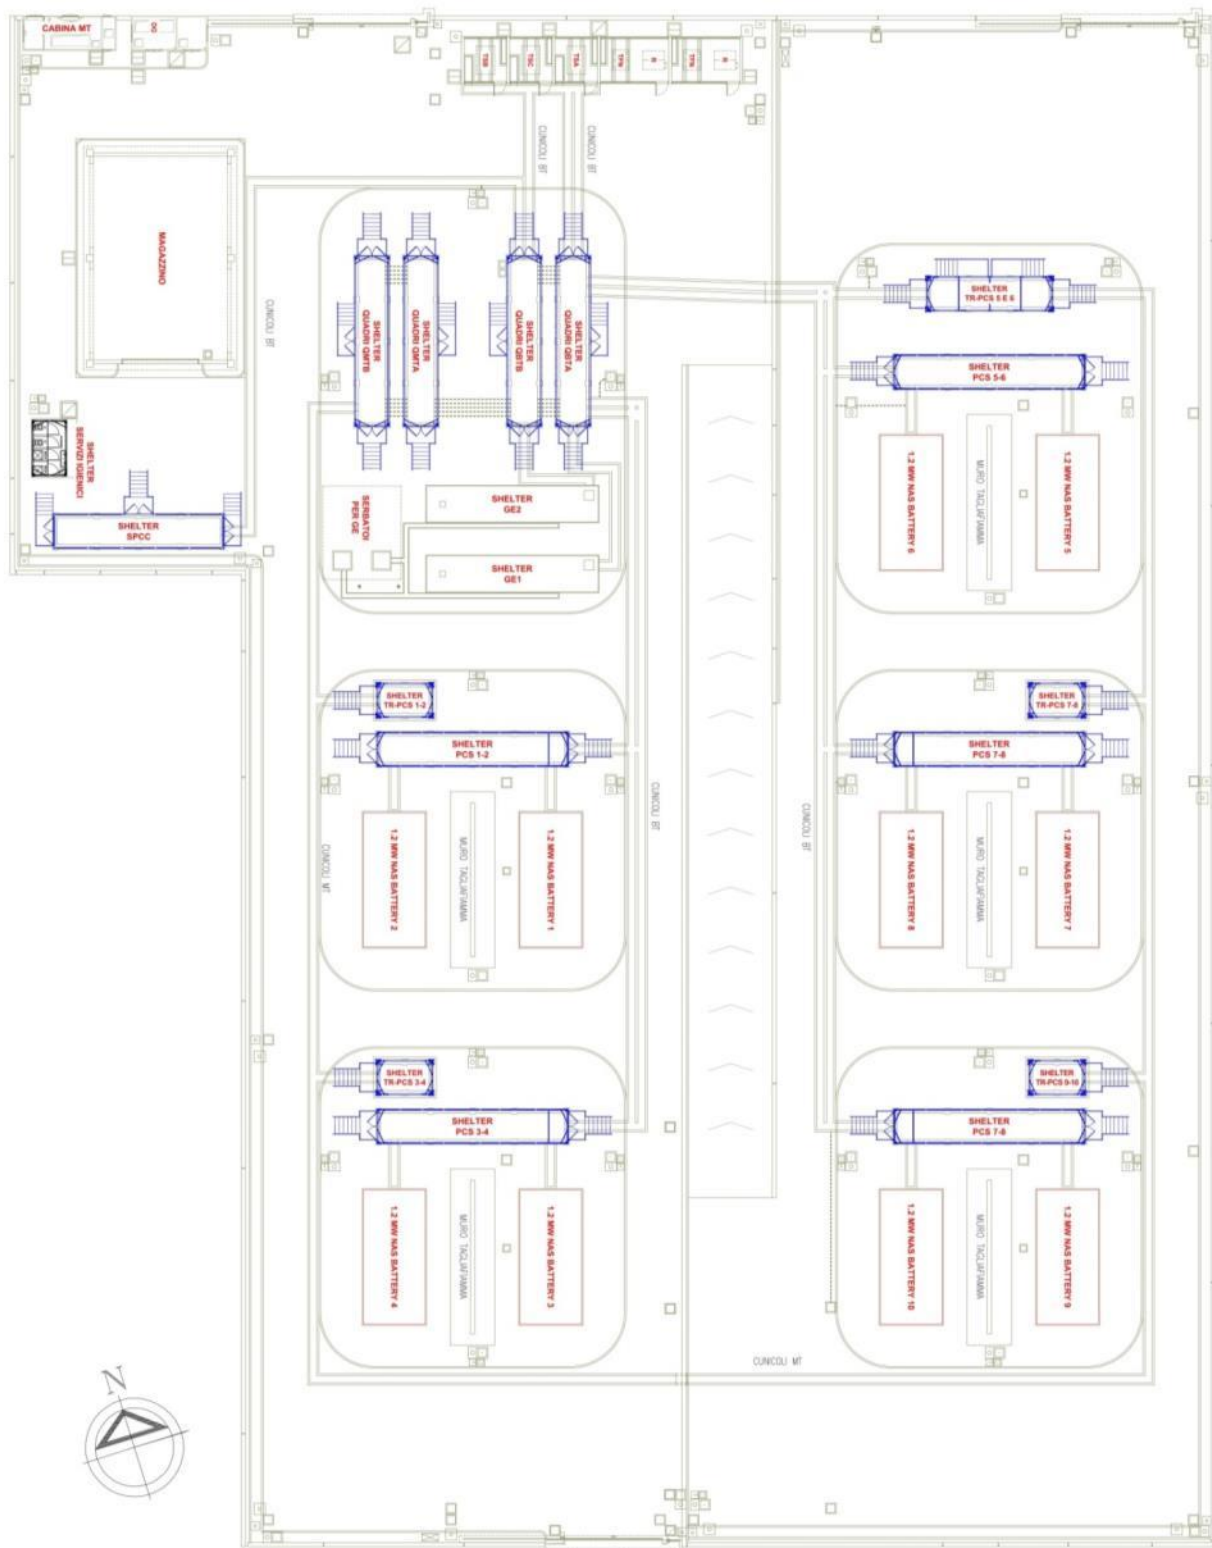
Layout elettromeccanico delle macchine ed apparecchiature installate nell'impianto GINESTRA SANC
